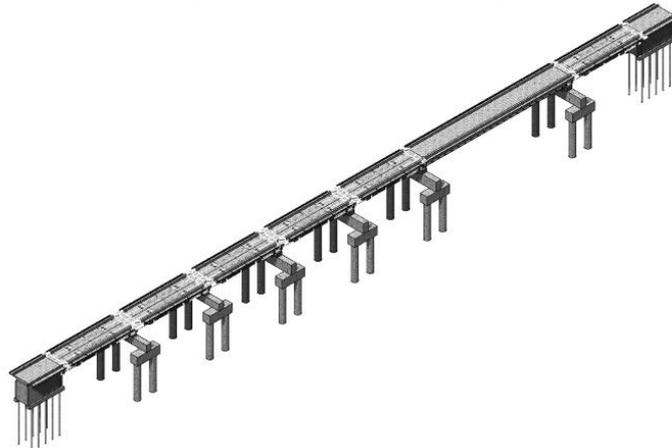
Estrutura da ponte sobre o Rio Paraíba do Sul após a obra de reforço elaborado com o auxílio do software Allplan Engineering.
